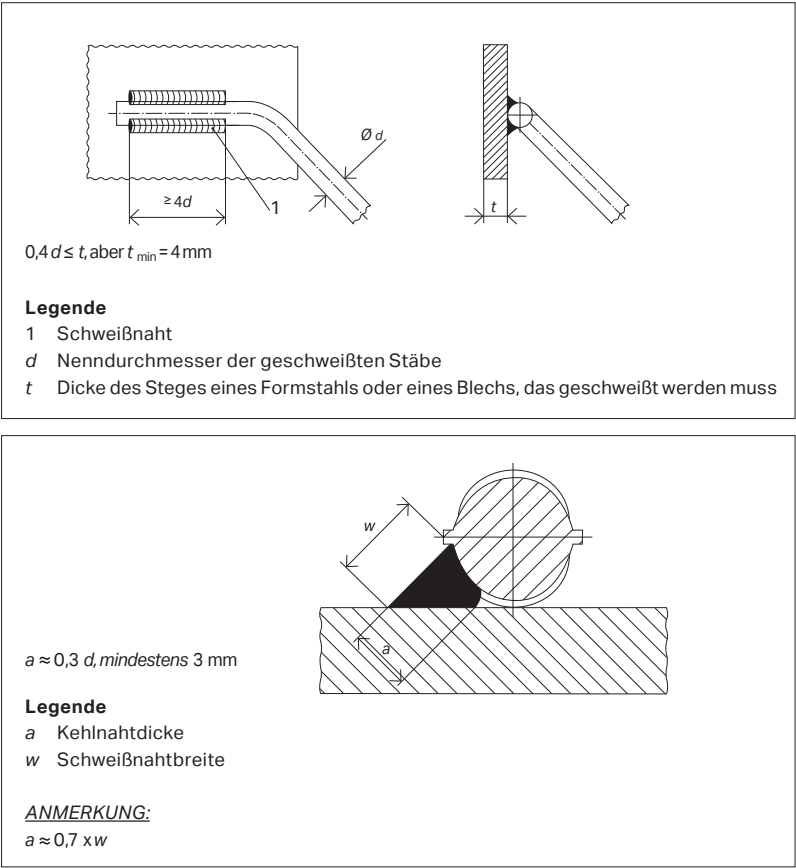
Geschweißte Flankenkehlnaht nach Kap. 6.6.2.1 – Bild 7 und 8
